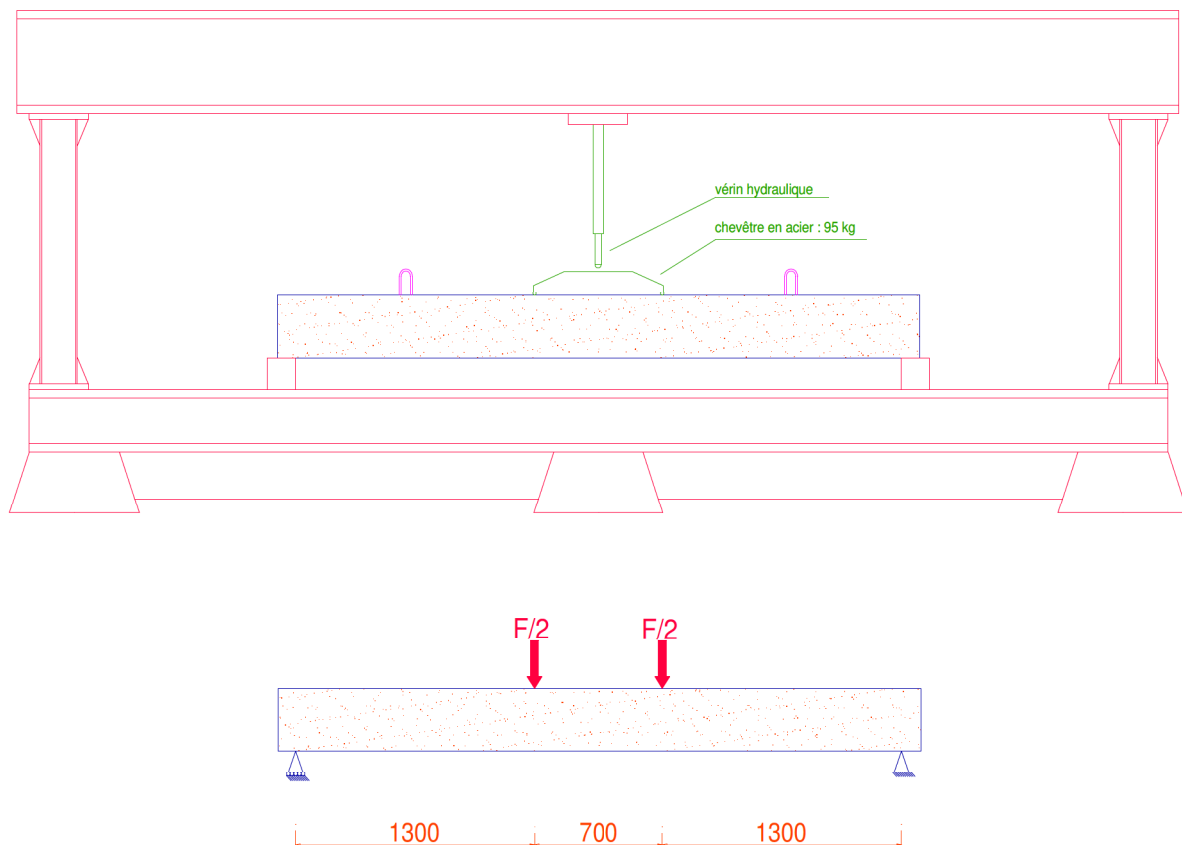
dispositif d'essai de la poutre en travaux pratiques
